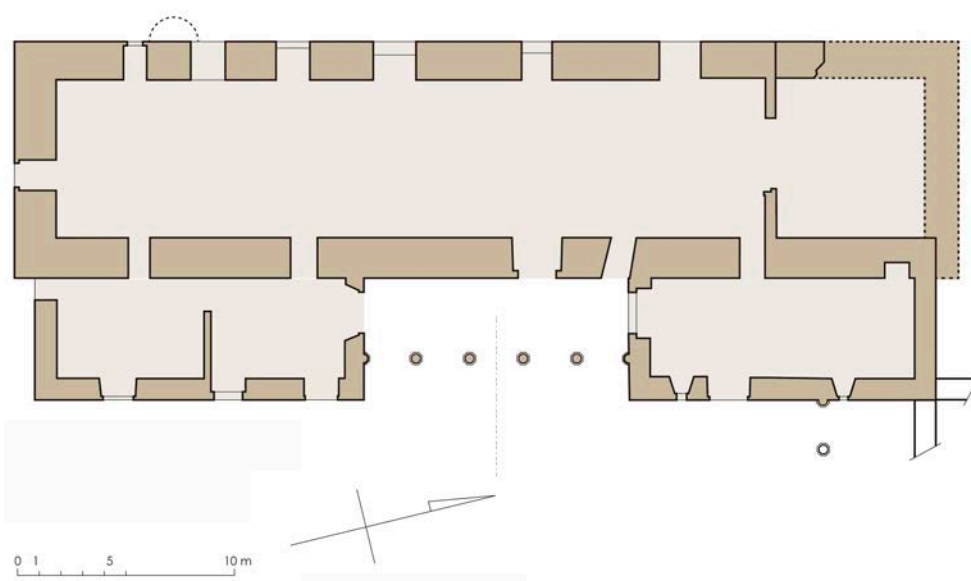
Palacio-villa de Casalarreina. Hipótesis gráfica sobre el estado del edificio en su segunda fase (planta baja y alzado fotográfico de elaboración propia, 2022). Mantenemos en planta algunos vanos de la planimetría de Sabrás Farias que carecen de vestigios al exterior o no son originales,
